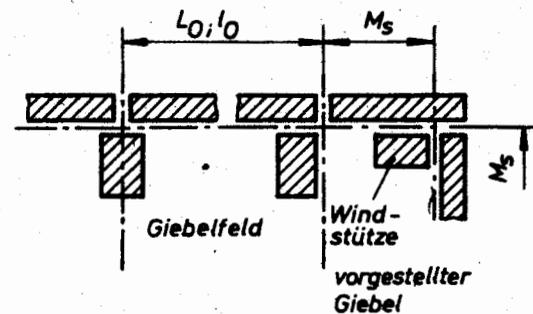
Lage der Außenwand eingeschossiger Skelettkonstruktionen
